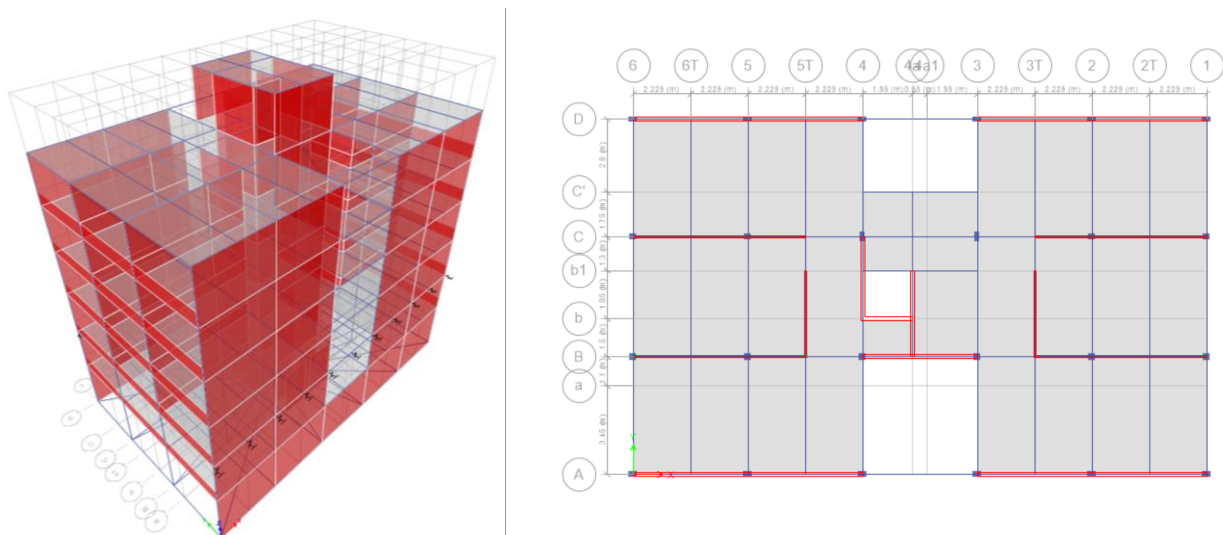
Vista 3D y planta piso tipo modelo I.
